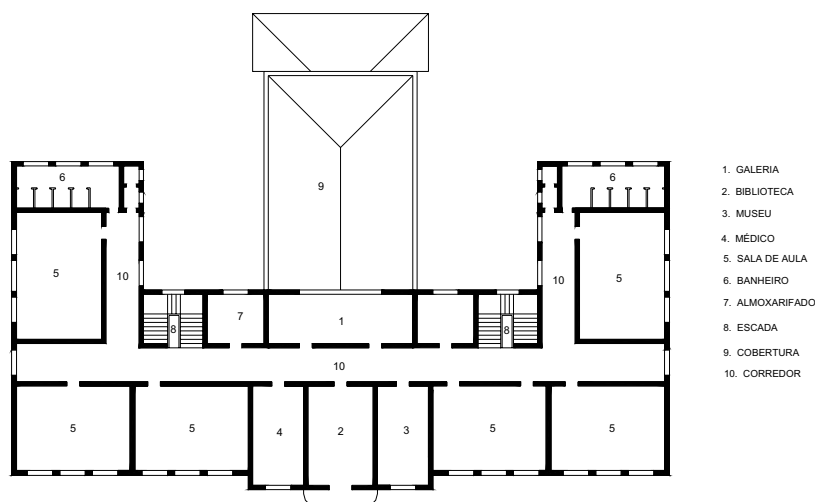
PLANTA DO PAVIMENTO TÉRREO DO GRUPO ESCOLAR CRISTO REI
